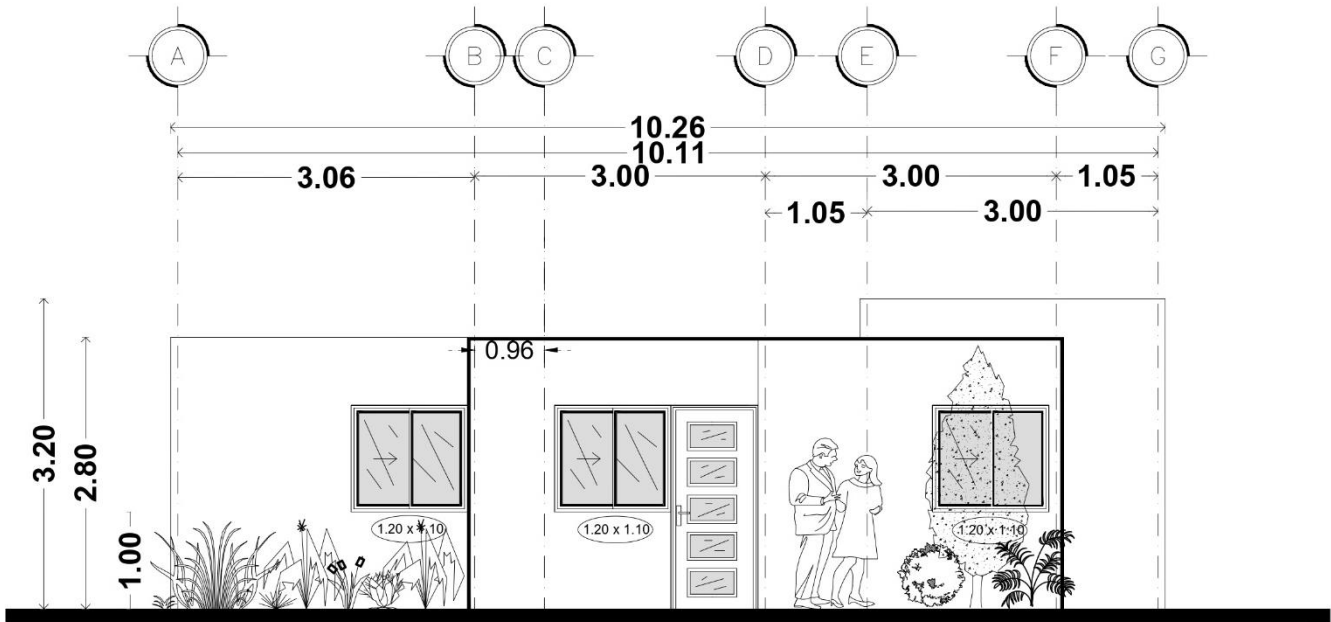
Planta de la propuesta de intervención. (18.952114, -98.979683).
